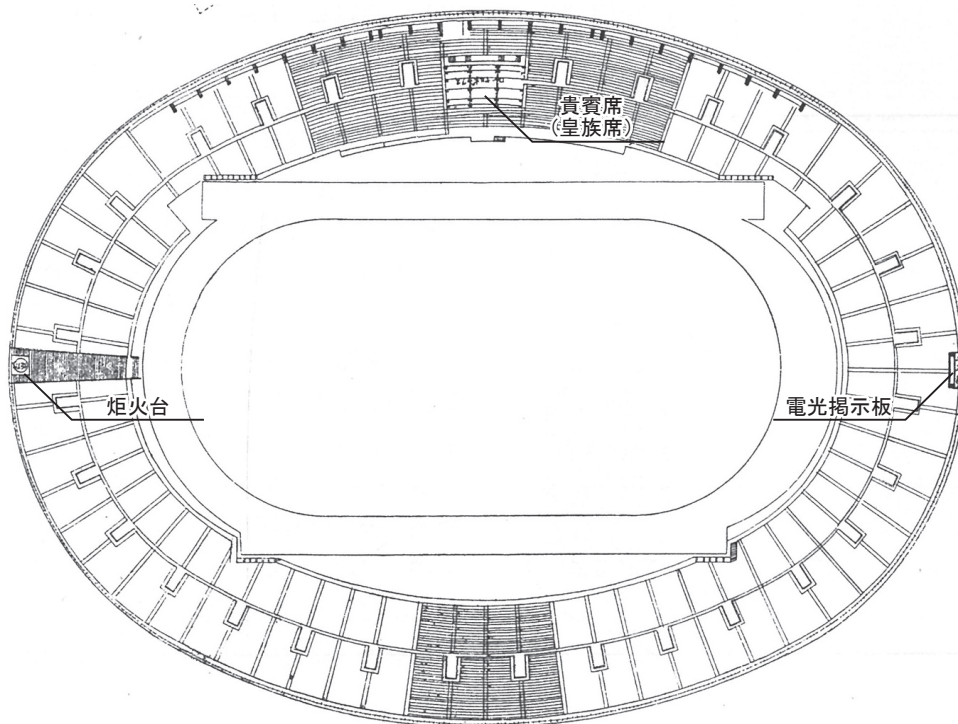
国立霞ヶ丘陸上競技場 平面図
